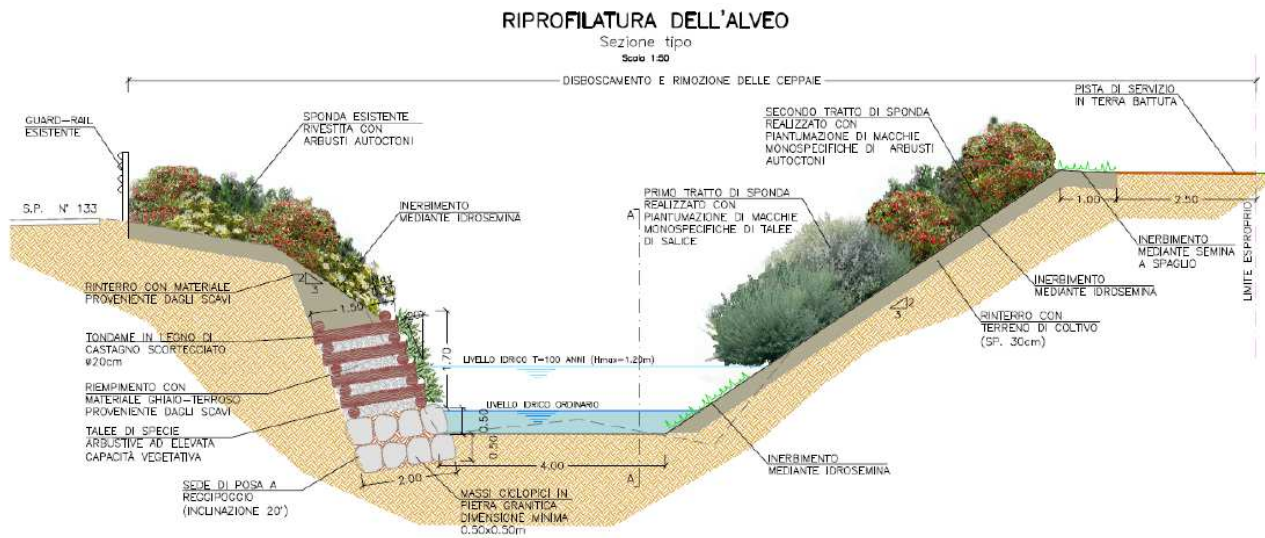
Sezione tipo del progetto di sistemazione del torrente Guisa.
